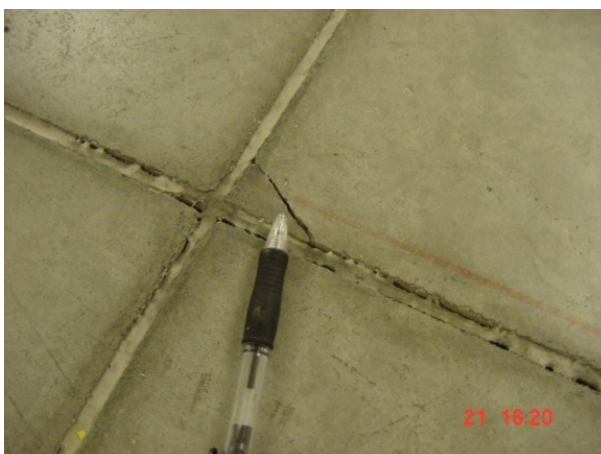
fisuras en las Esquinas de las losas
